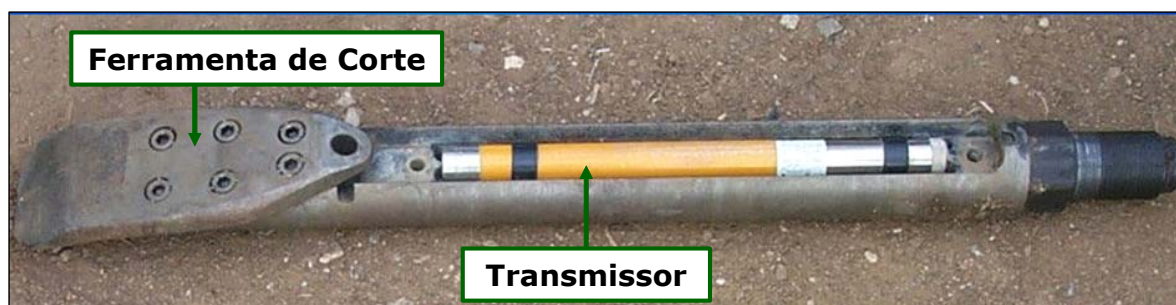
25 – Cabeça de Perfuração com transmissor e ferramenta de corte instalados
